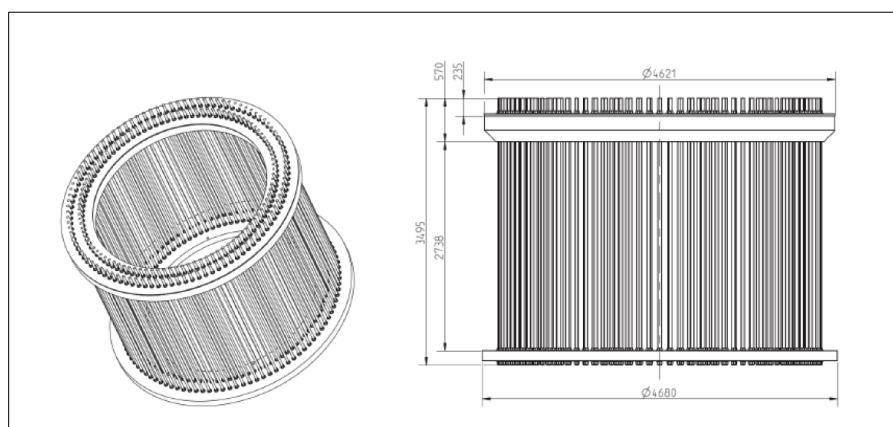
ESEMPIO VIOLA DI FONDAZIONE
